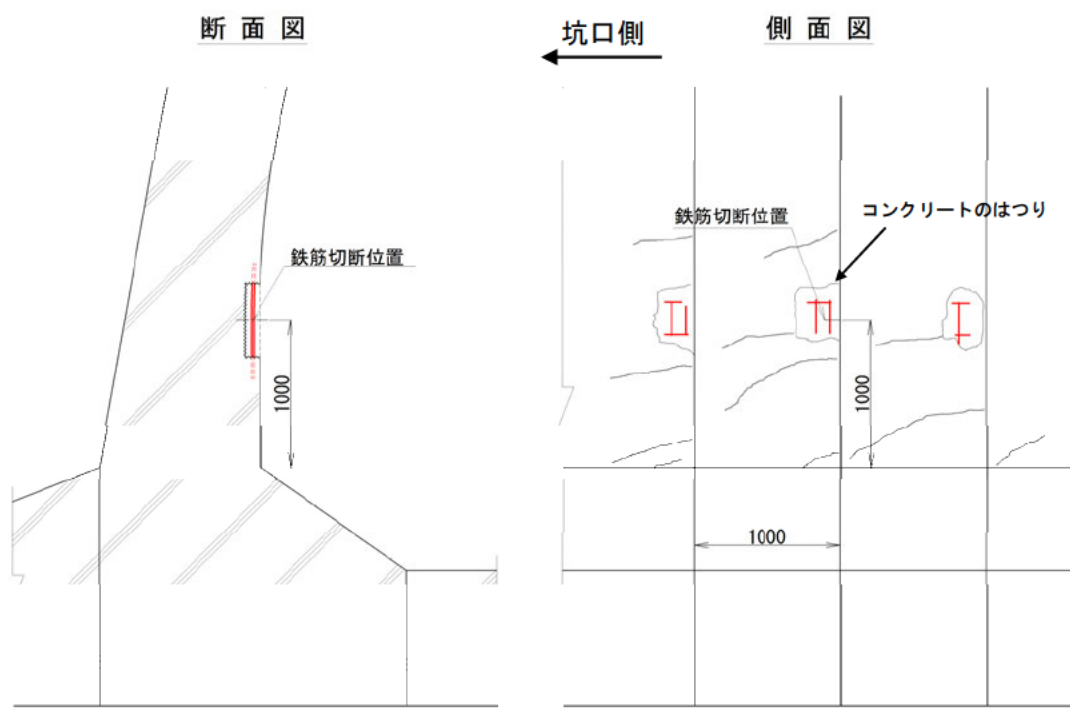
部材の脚部ひび割れ状況と応力計測
